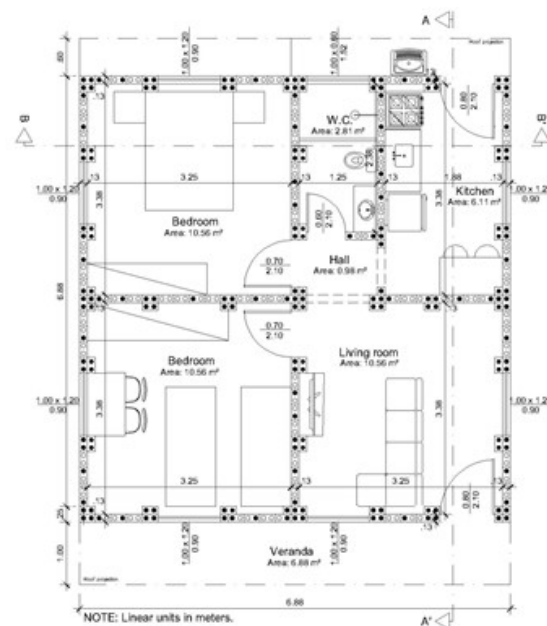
Planta baixa da Casa SHS-Multirisco 1.0 [14].
